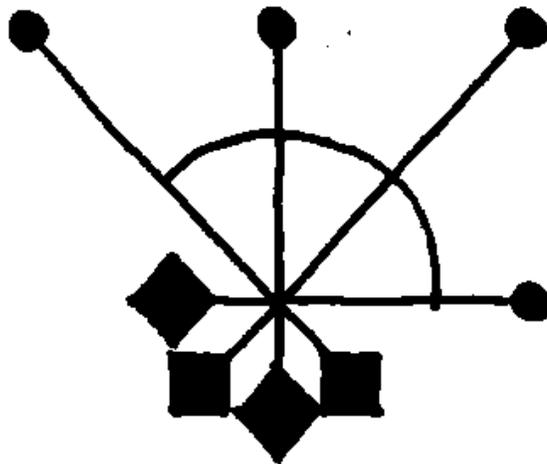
Croquis de la planta de la Parroquia del Perpetuo Socorro.
